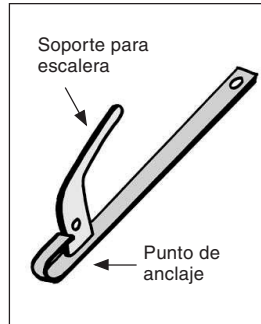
Detalle de un dispositivo de anclaje para cubiertas inclinadas
